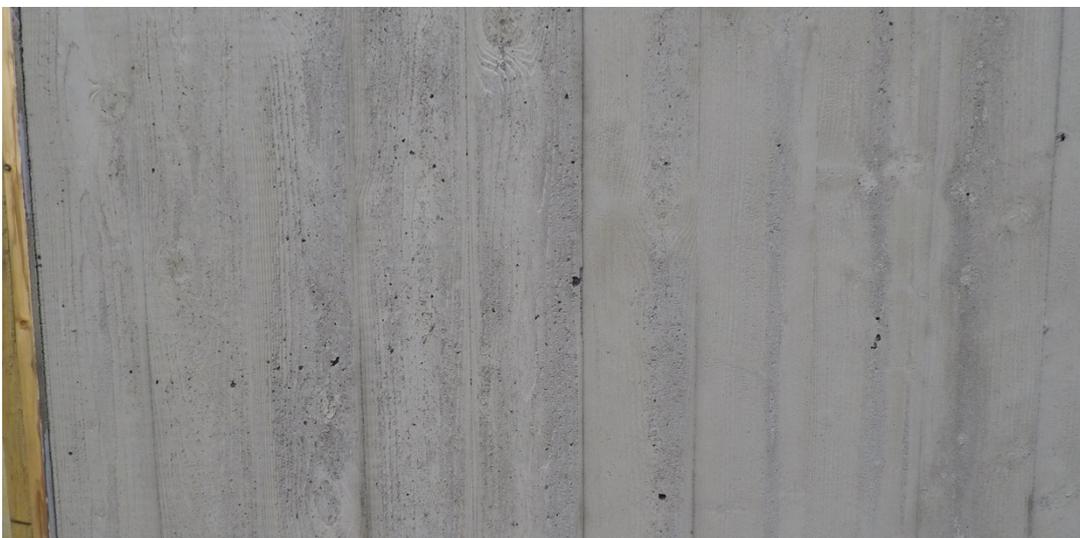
Vergleich Betonabriss mit neuen und alten Brettern direkt nach dem Ausschalen
